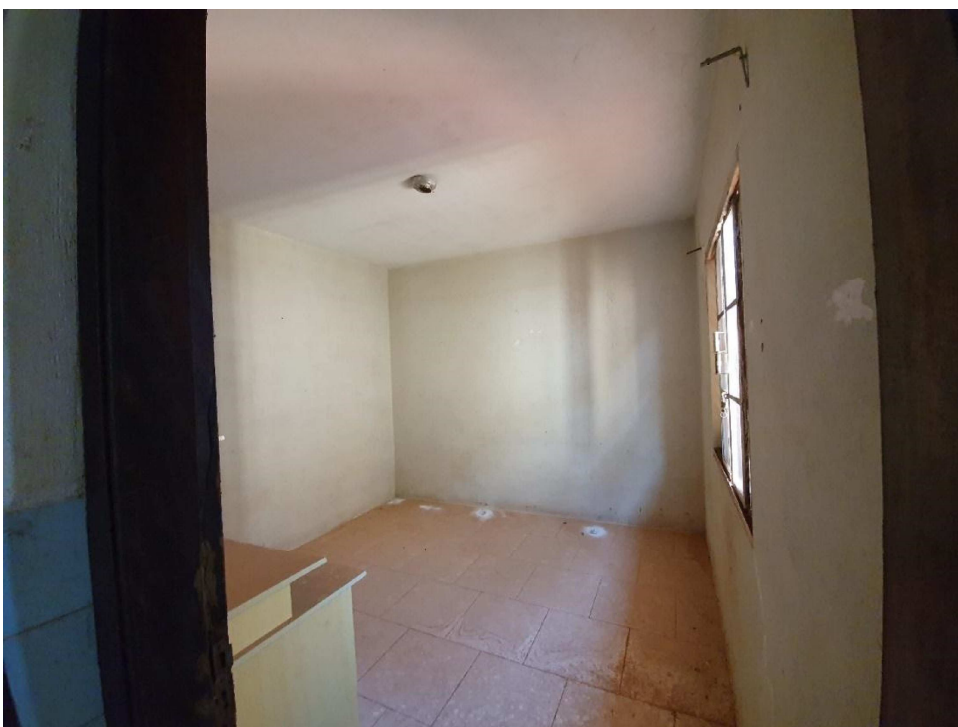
Detalhe da rachadura na laje a qual desce em ângulo pela parede onde se encontra a janela do quarto.
